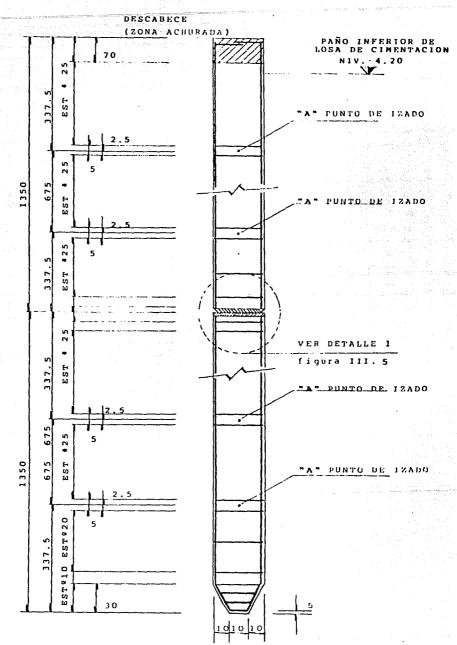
VISTA GENERAL DE PILOTE TIPO Y SU ARMADO (Dimensiones para el Puente Canal de San Juan)
